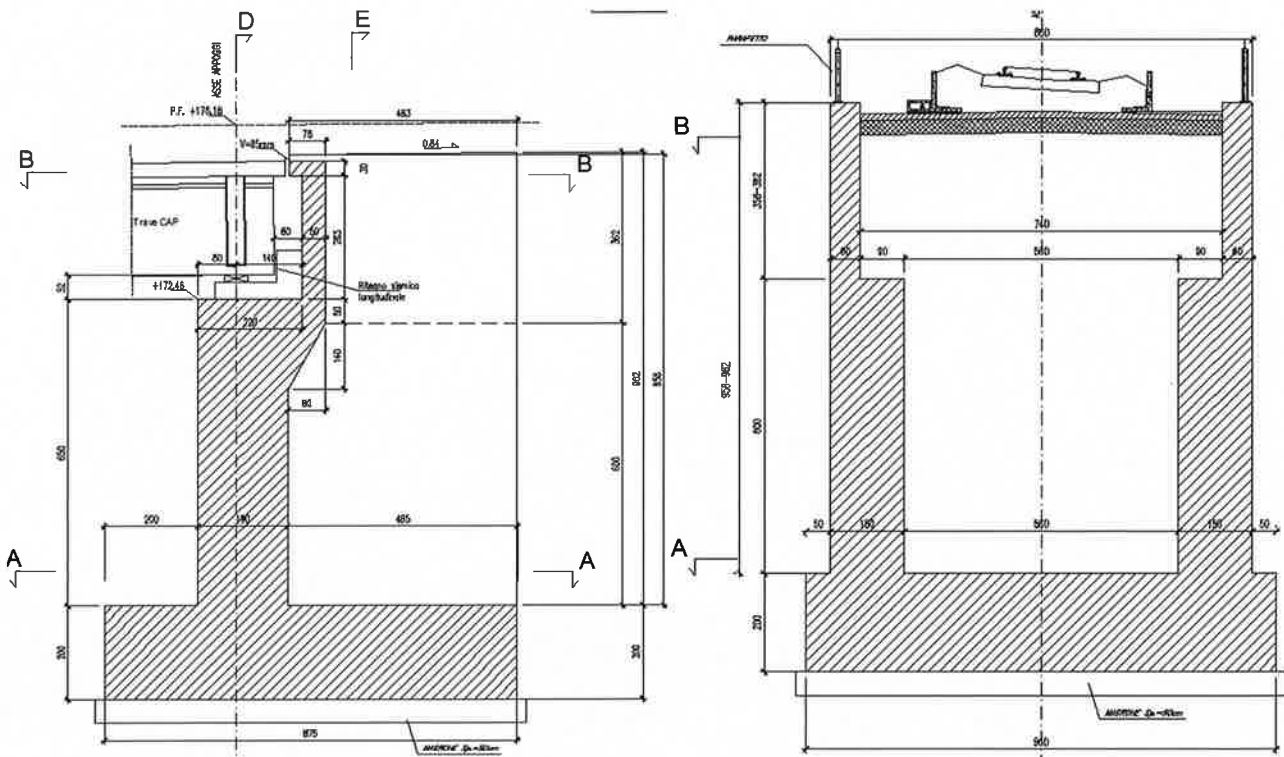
Sezione longitudinale e trasversale spalla B Bauladu VI02
